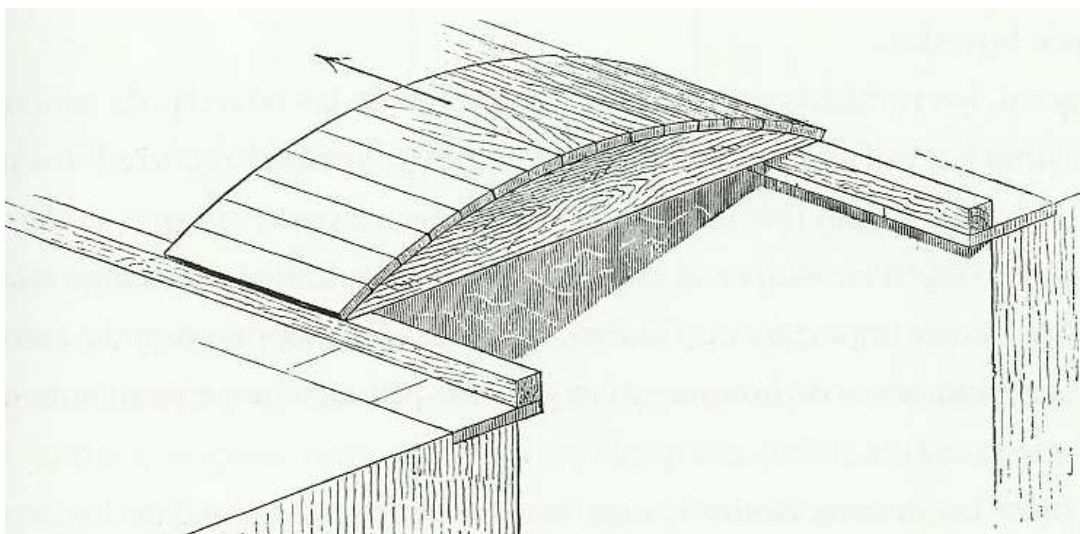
Detalle de cimbra móvil (Imagen 37 en Choisy (1999:61)).
